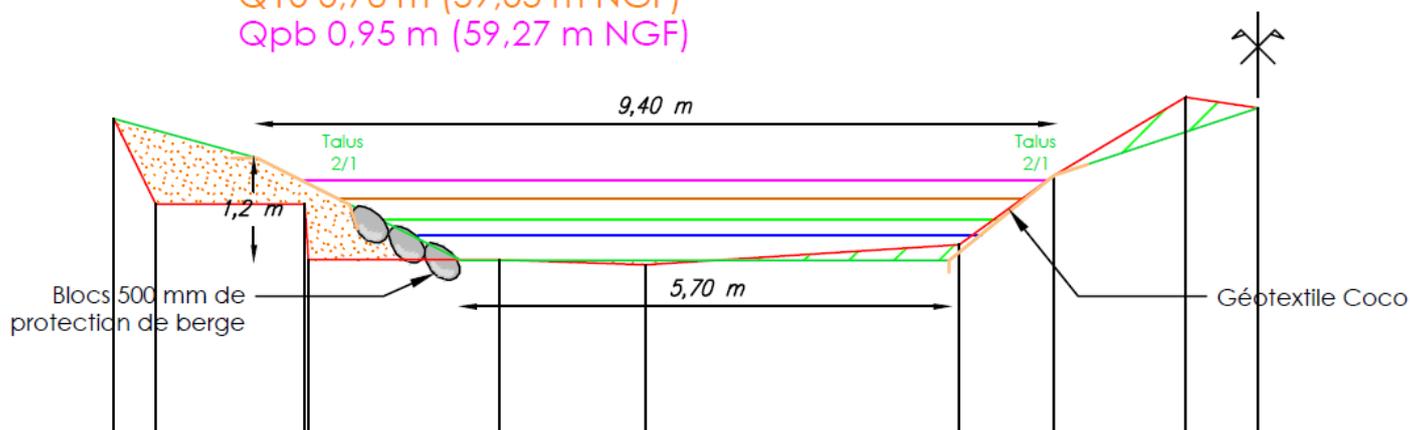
Profil en travers au droit des enrochements au niveau du pont de la route (PT9)
